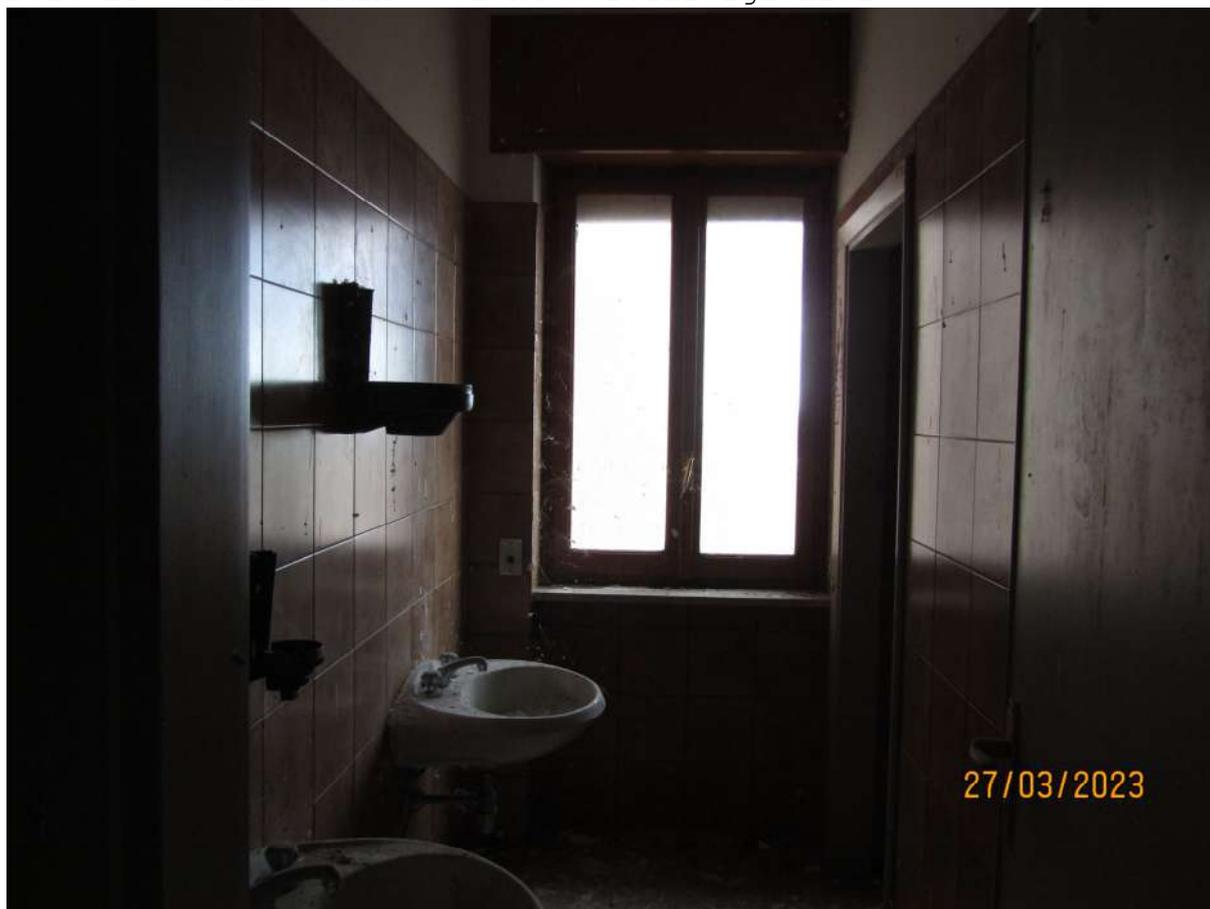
PIANO PRIMO - zona servizi igienici.
